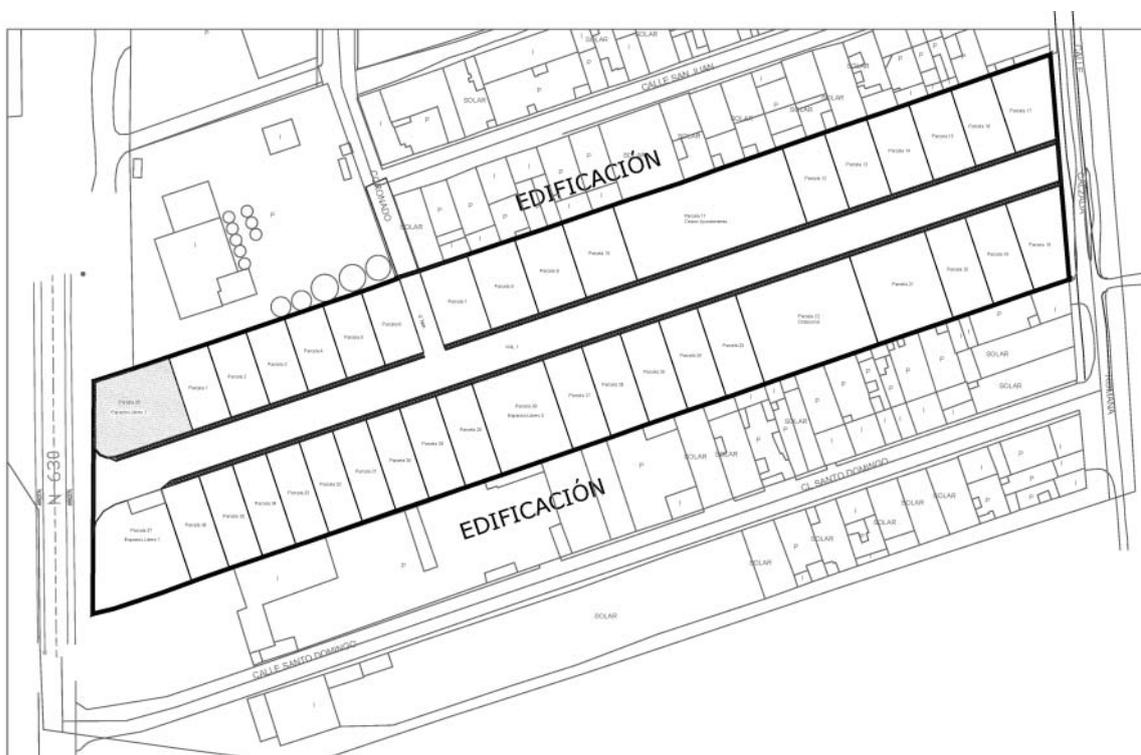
FIGURA DE PLANEAMIENTO: Plan Parcial Sector 1.
